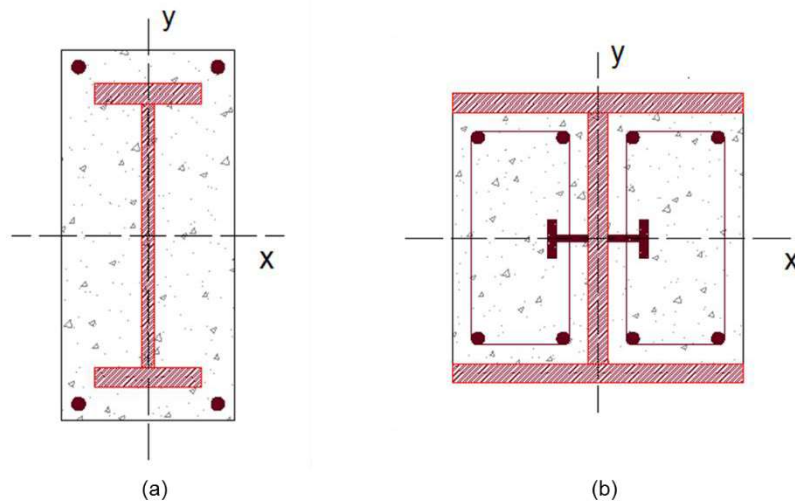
Pilares revestidos. (a) Pilar totalmente revestido por concreto, (b) Pilar parcialmente revestido por concreto.
